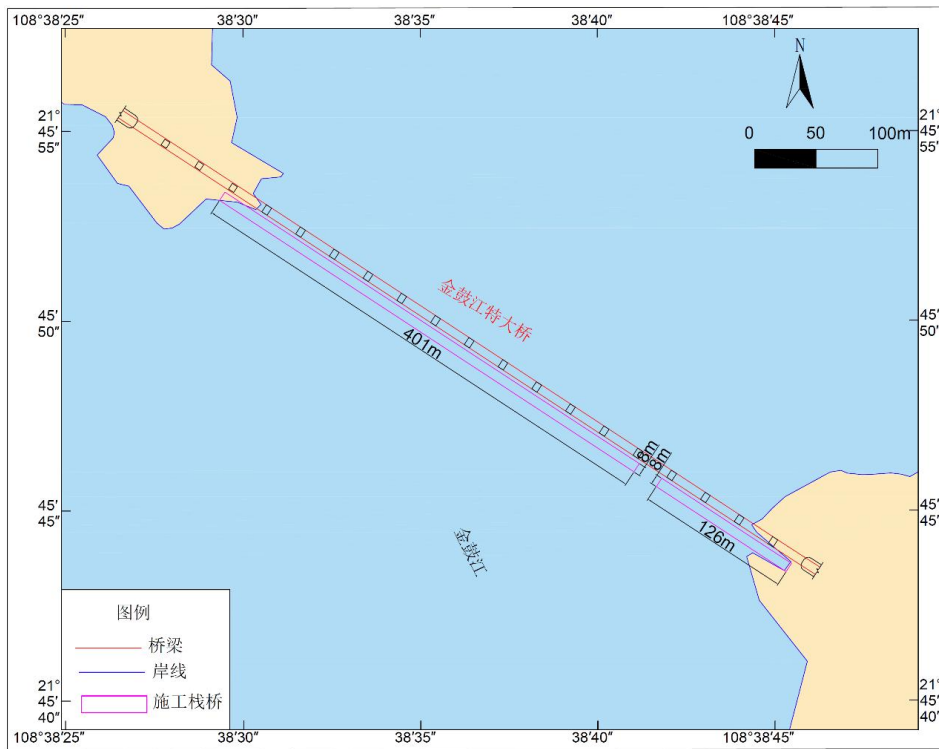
金鼓江特大桥施工栈桥平面布置图
